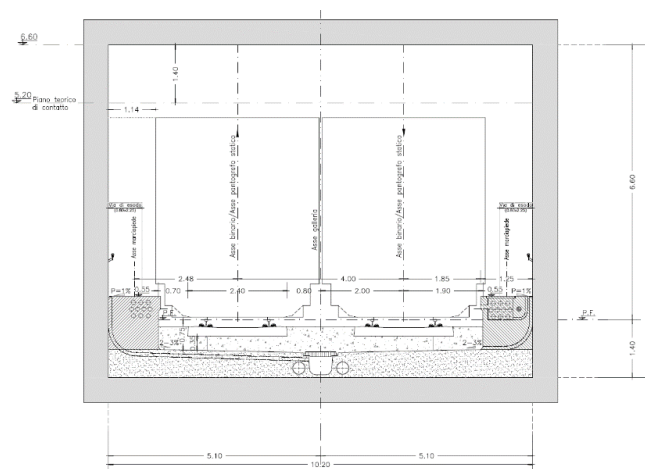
dimensioni interne sezione GA da Manuale di Progettazione RFI.
